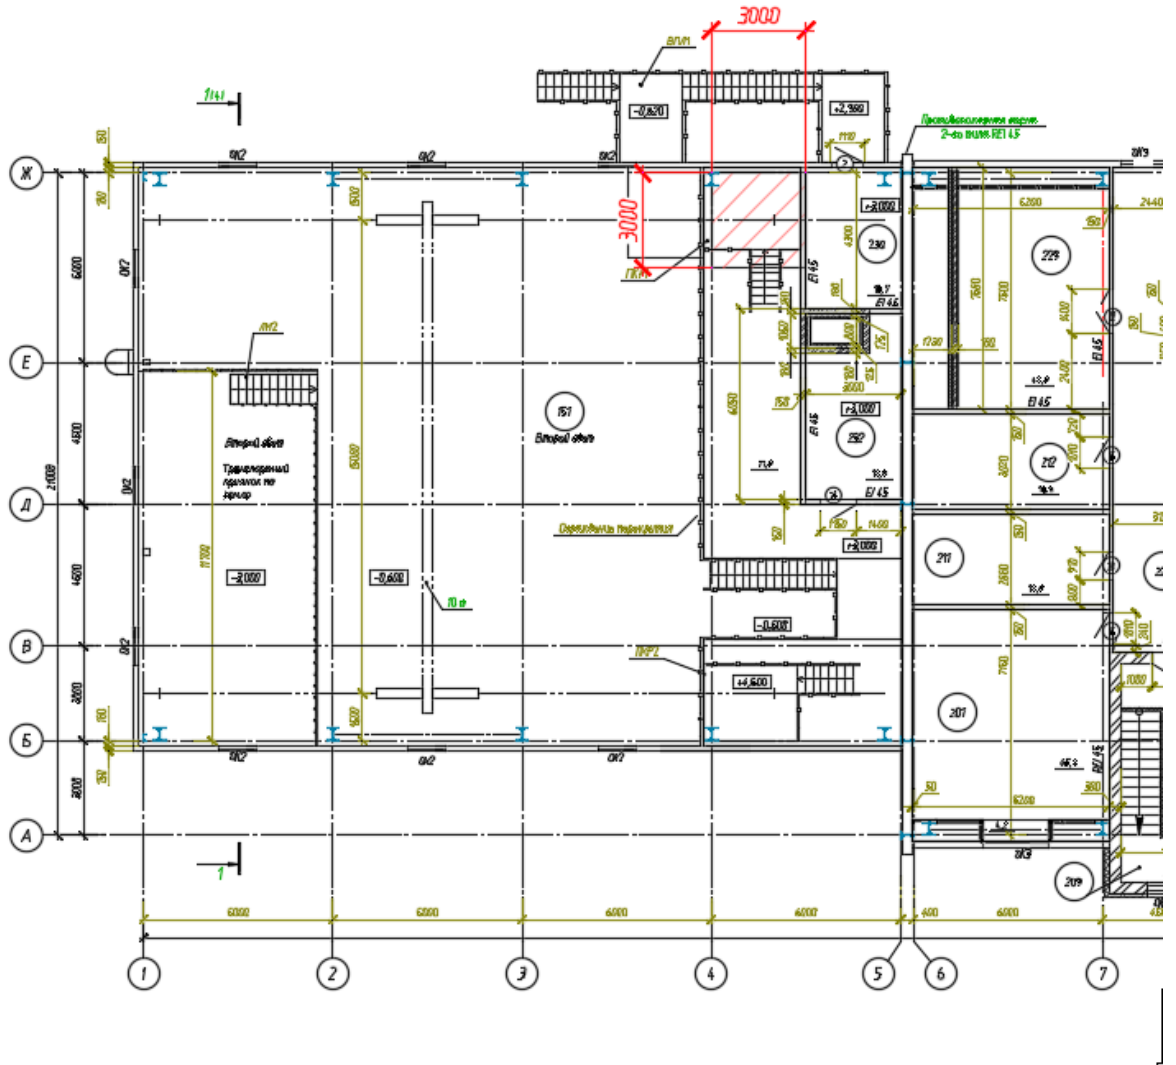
Грузовая площадь колонны на отметке плюс 3,0 м
